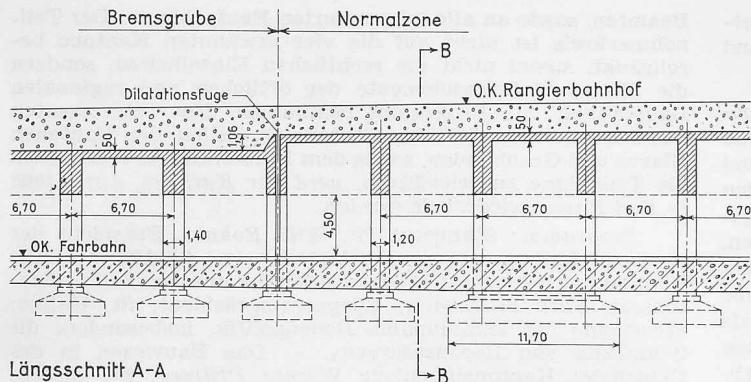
Autobahn-Galerie Schweizerhalle, Schnitte 1:500. Man beachte die aussergewöhnlichen Abmessungen der Eisenbetonkonstruktion
